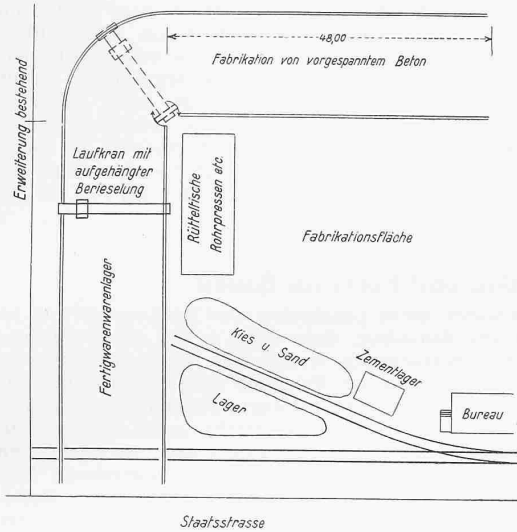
Anwendung in einer Betonwaren-Fabrik
